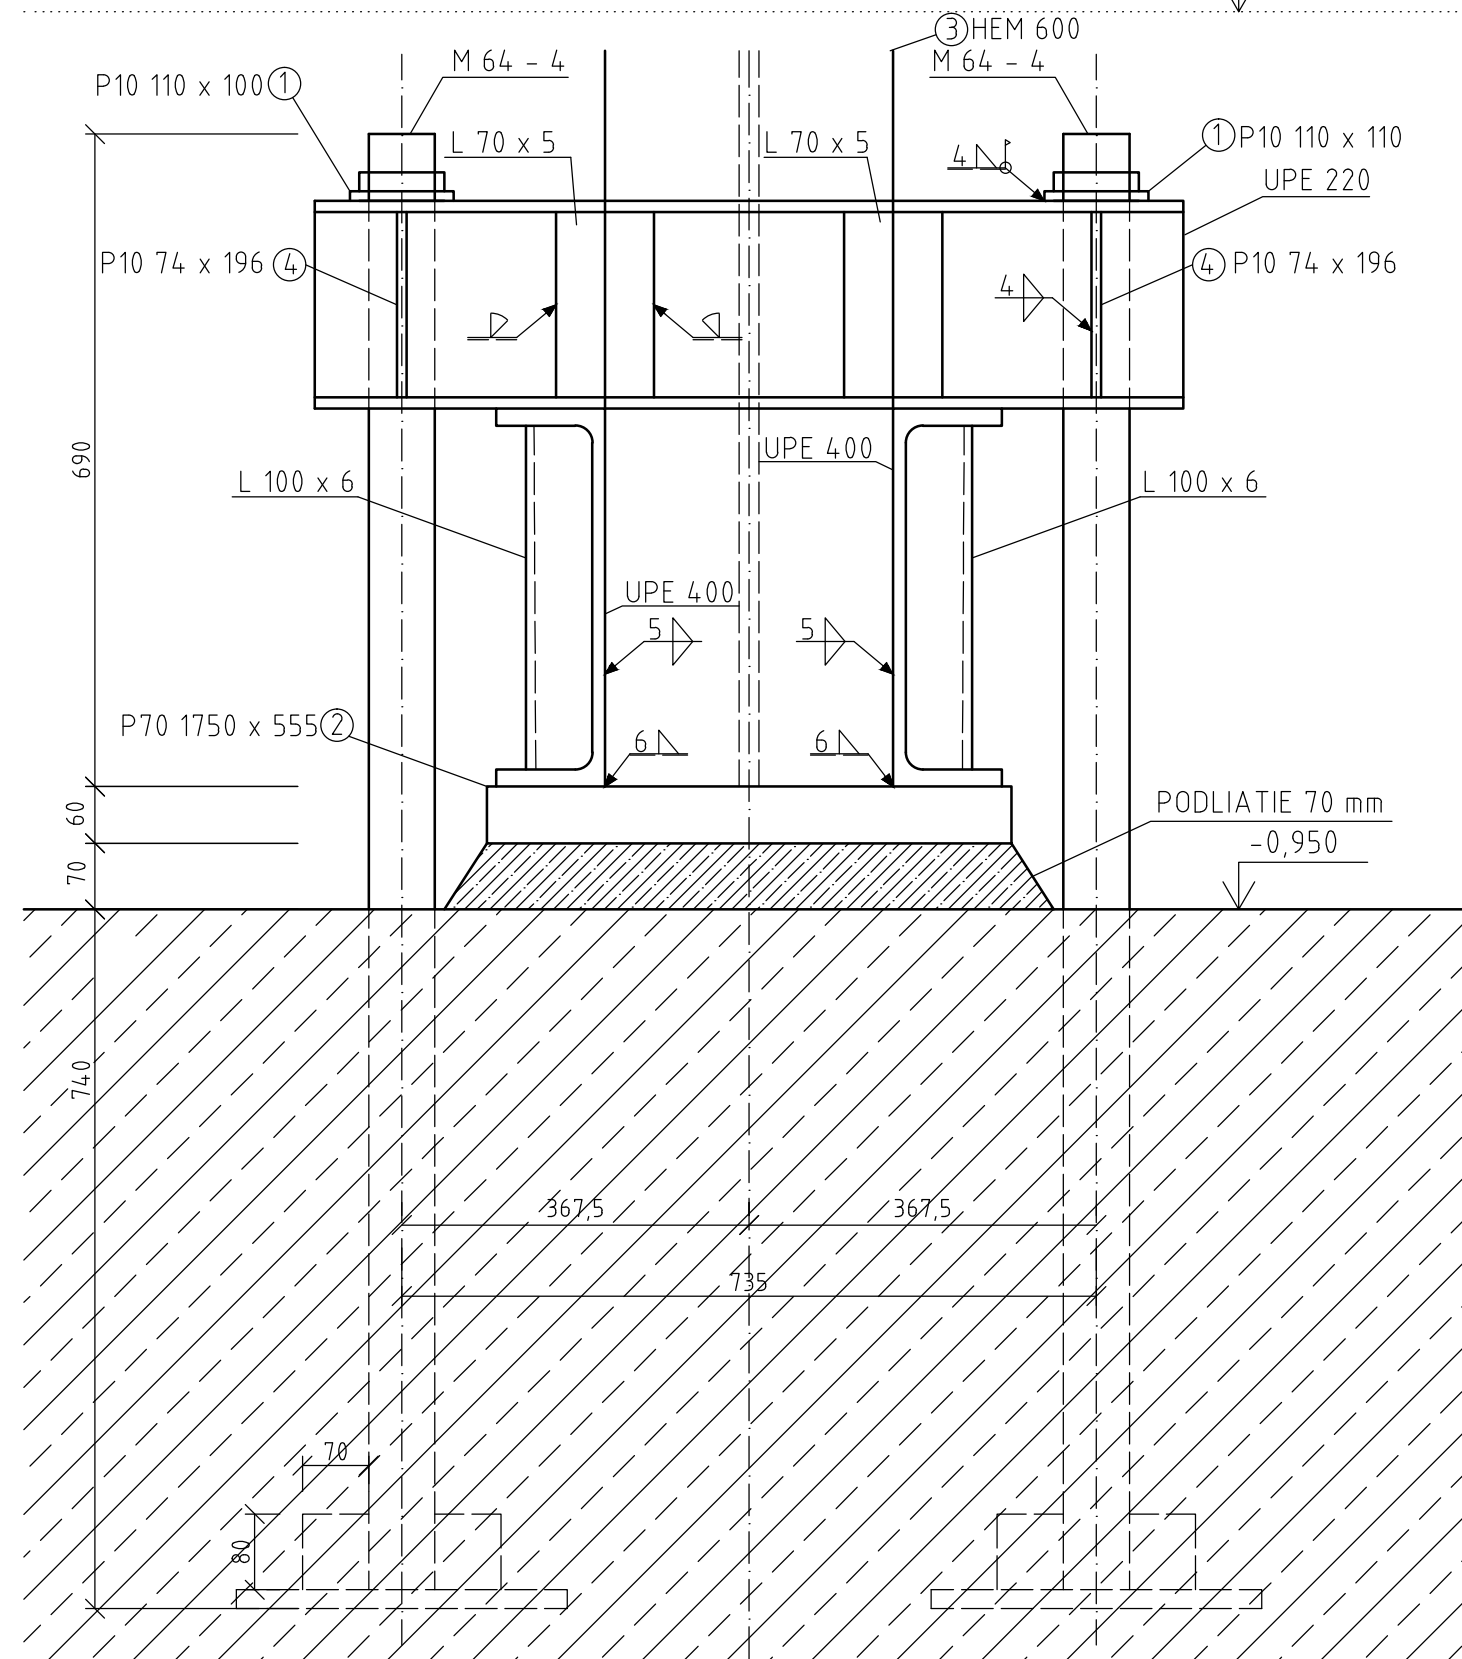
DETAIL SKRUTKY S KOTVIACOU HLAVOU
